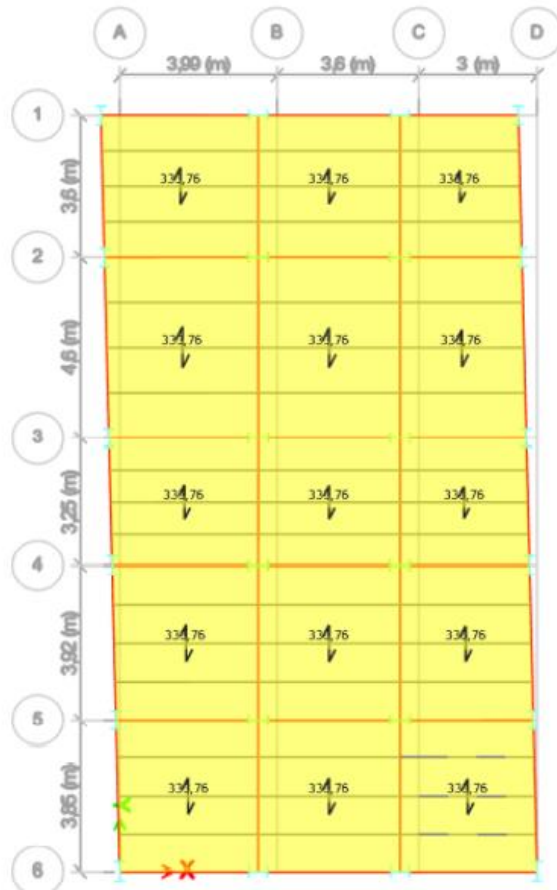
Vista del primer piso en un plano X-Y diseñado en ETABS.
